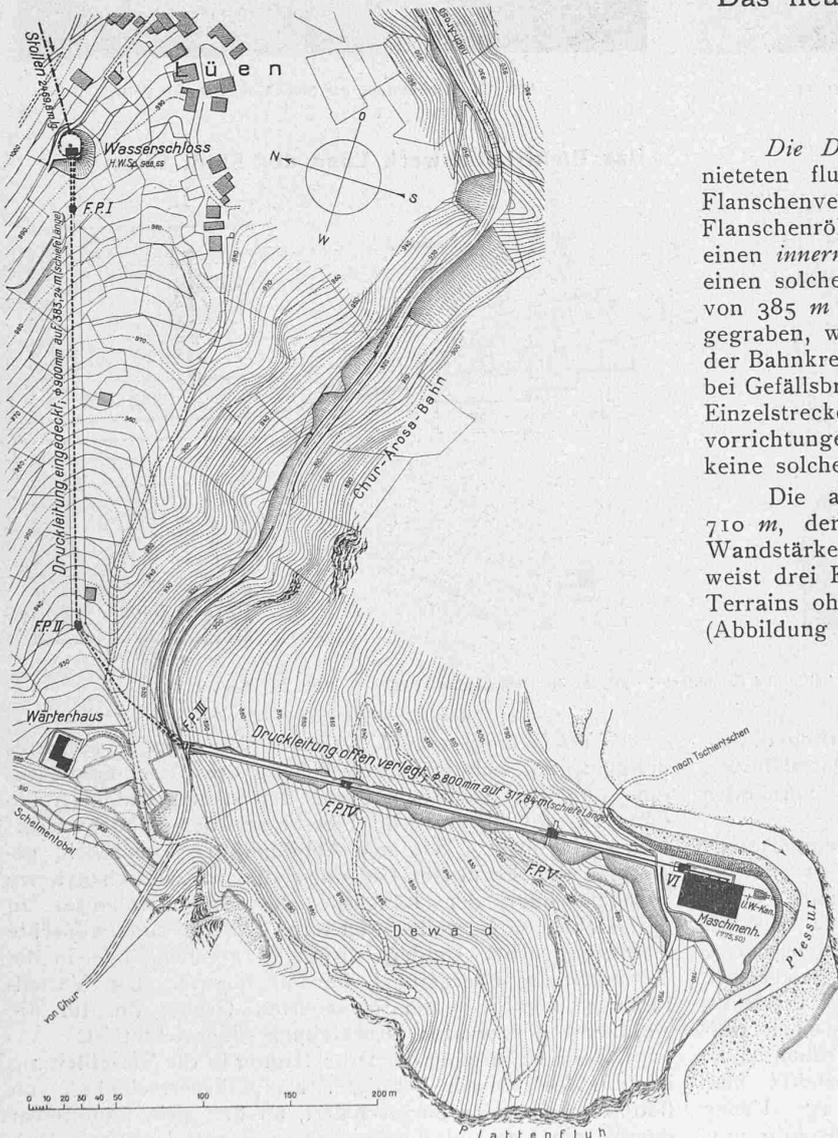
Wasserschloss, Druckleitung und Zentrale bei Lügen. — Lageplan 1:4000.
